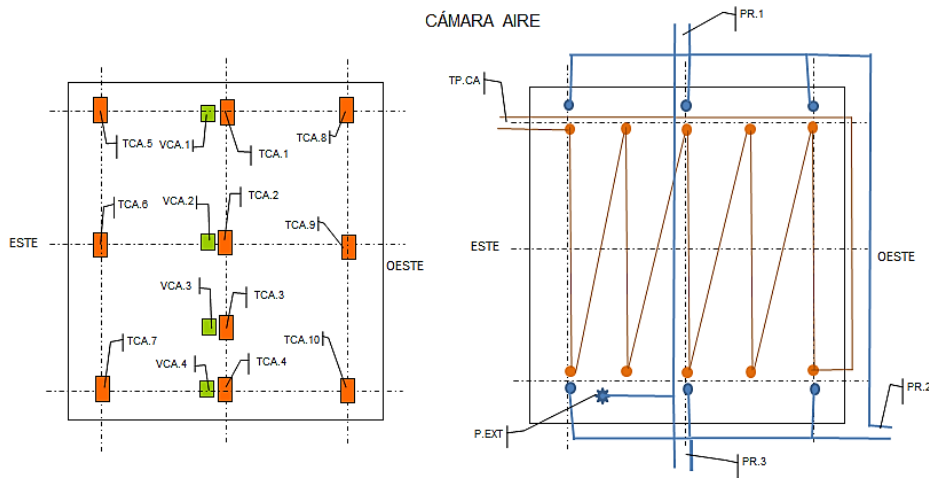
Instrumentación instalada en la cámara de aire de la fachada ventilada pesada
